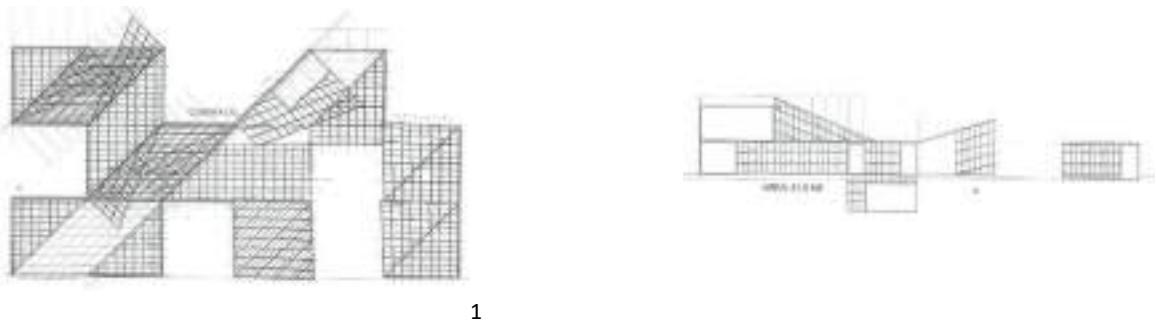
1 y 2. Planos de montaje fachada-cubierta (superposición subestructura y revestimiento).
